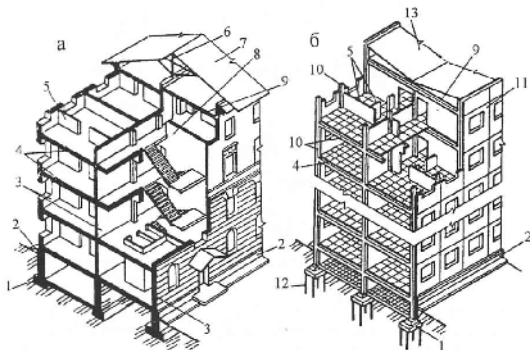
Основные элементы здания: а - с несущими наружными и внутренними стенами; б - с каркасом: 1 - фундамент; 2 - цоколь; 3 - несущие продольные стены; 4 - междуэтажные перекрытия; 5 - перегородки; 6 - стропила крыши; 7 - кровля; 8 - лестничная клетка; 9 - чердачное перекрытие; 10 - ригели и колонны каркаса; 11 - навесная наружная стена; 12 - сваи; 13 - кровельная панель.
